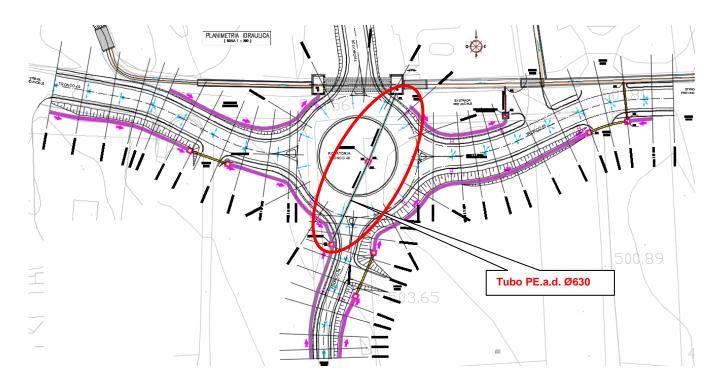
Stralcio planimetrico da Progetto di Dettaglio
